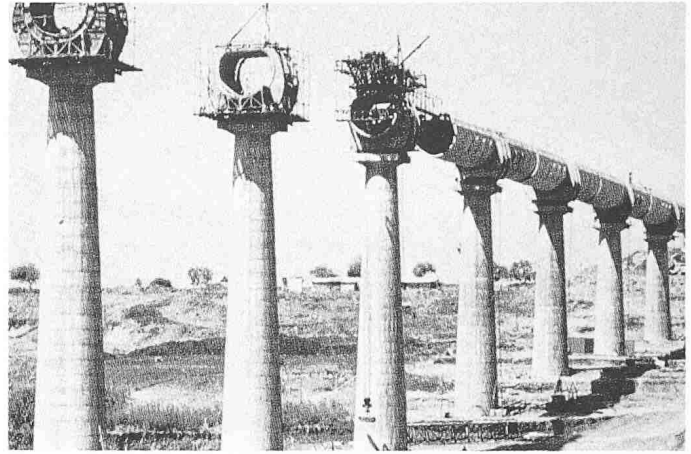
Aquädukt in Indien: Vorfabrizierte Betonelemente im Freivorbau mit Klebefugen
